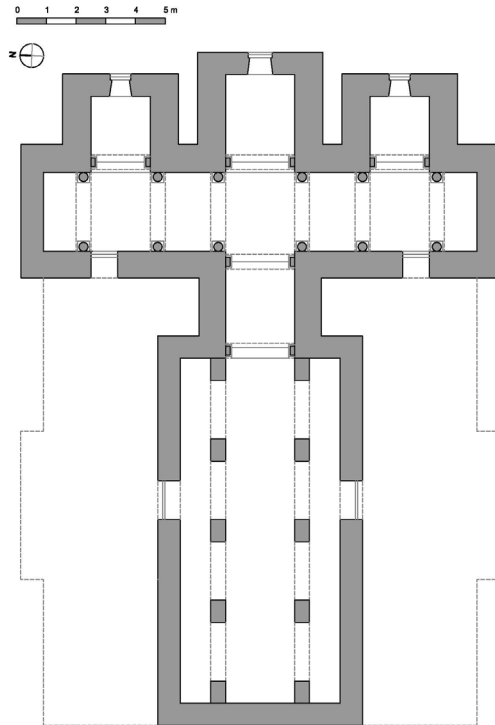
Planta de replanteo. Rectificación segunda para igualar las luces de arcos en los cruceros del transepto (elaboración propia).
